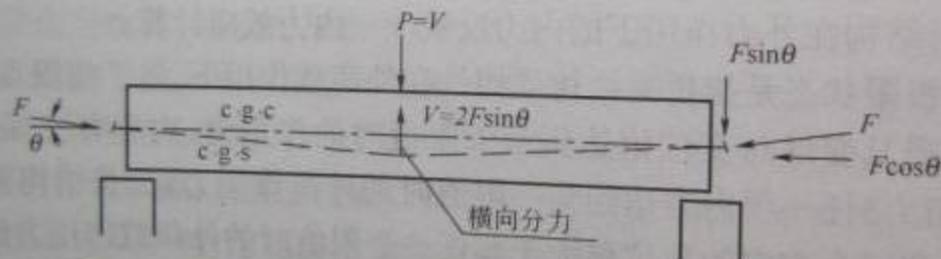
平衡-集中荷载[《预应力混凝土结构设计》之图11-2(原著图号)]
